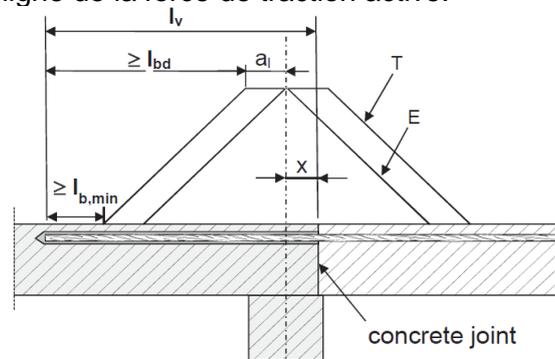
Ancrage en extrémités de dalles ou poutres en appui simple
